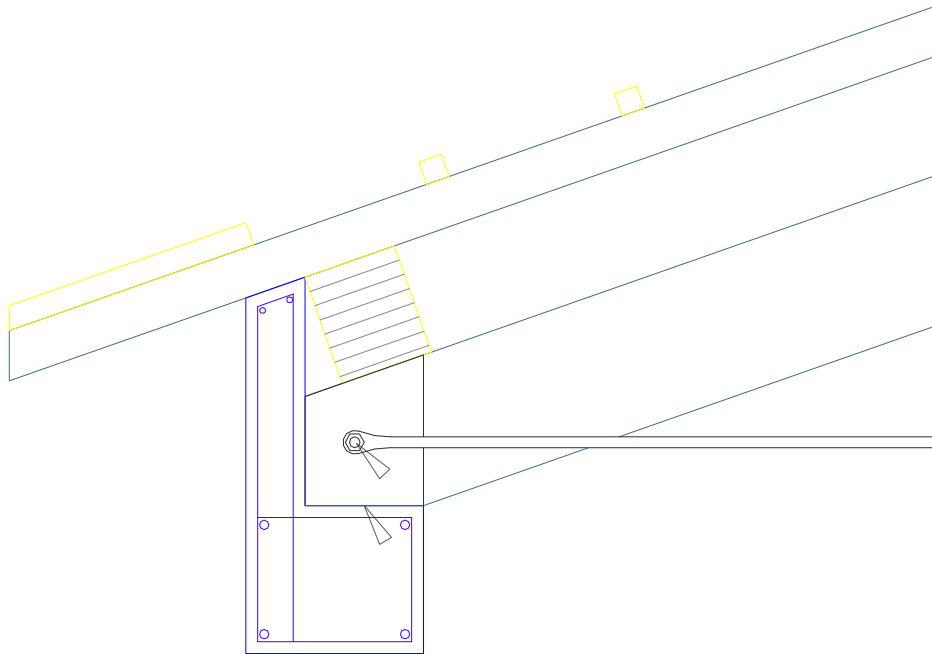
Possibilités ancrage ferme / poutre en béton armé
